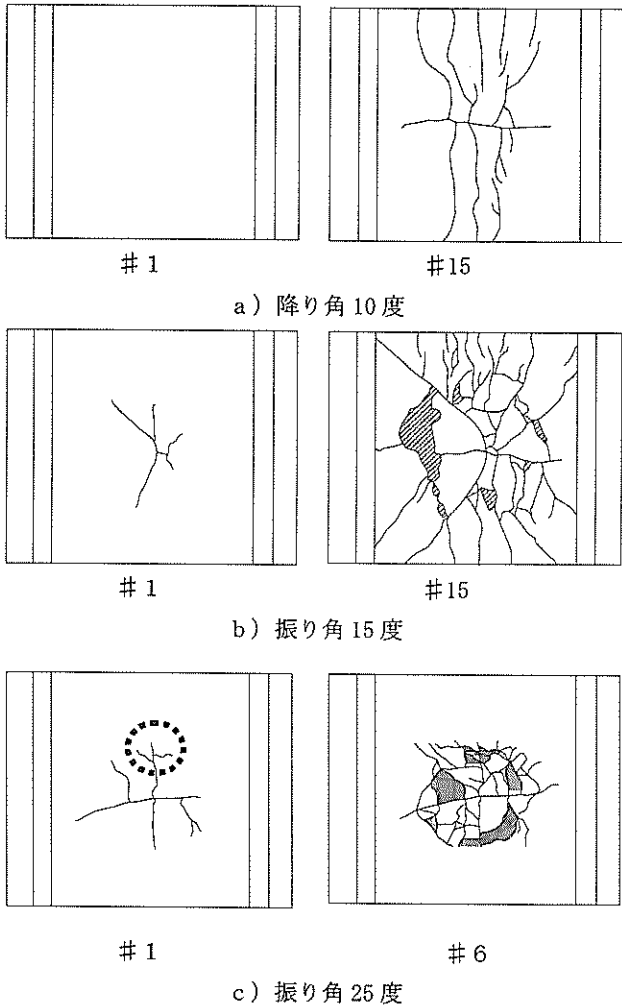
衝突背面のひび割れの様子 (水中衝突)
